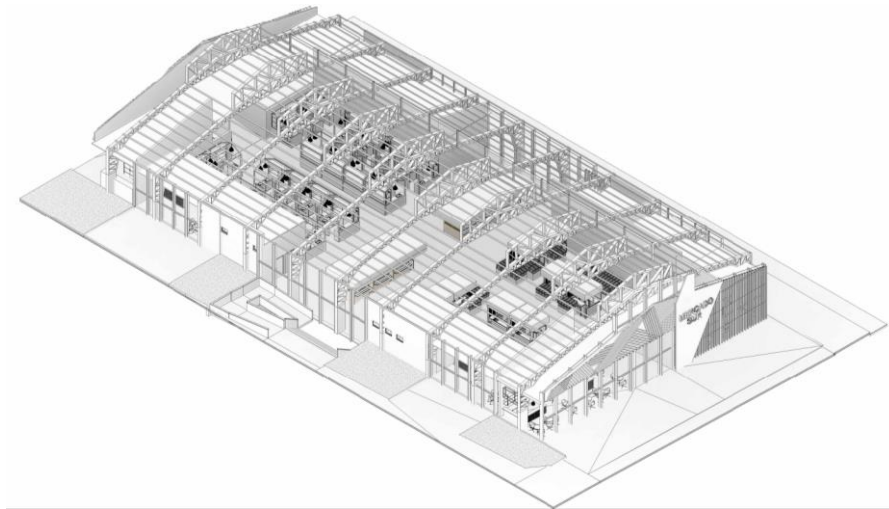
Estructura de la cubierta. Elaboración propia (2023).
